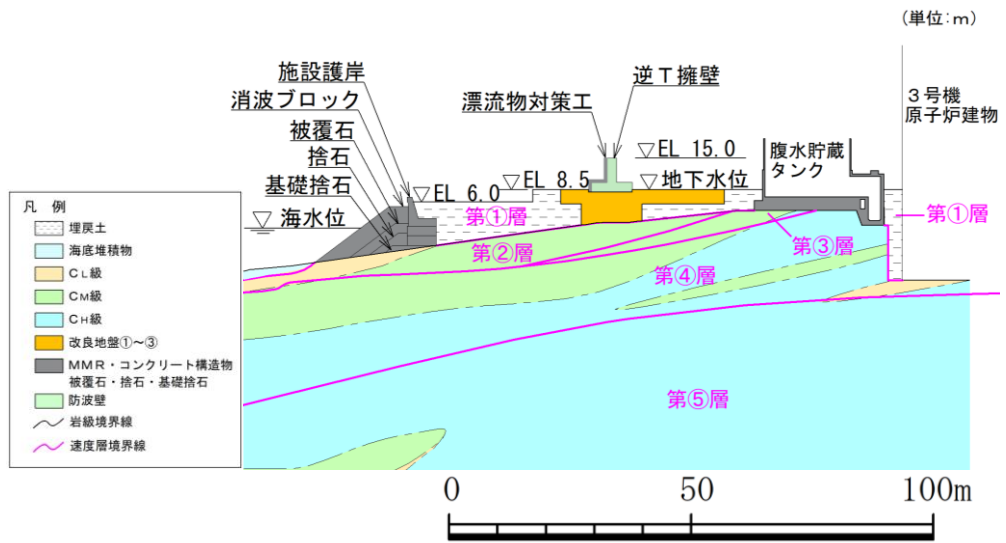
防波壁（逆 T 擁壁）の横断面図（③-③断面）
